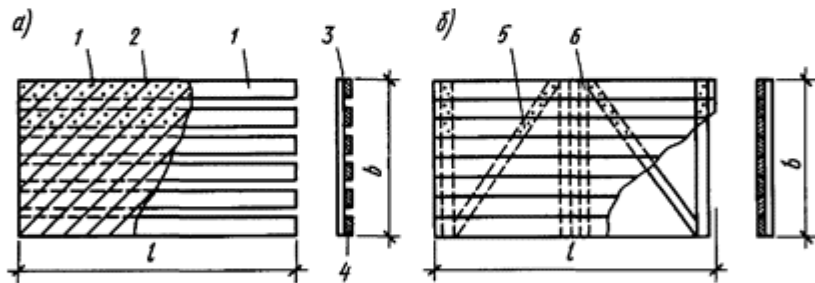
Дощато-цвяхові щити настилів покриттів:
